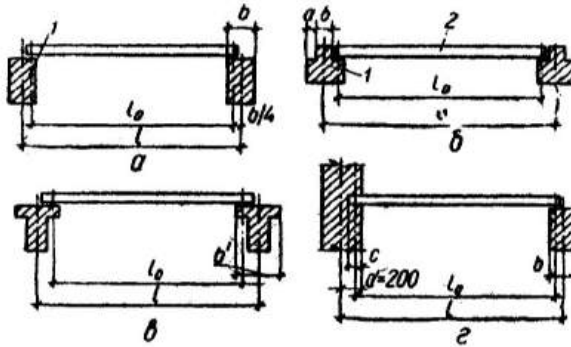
Розрахункові прольоти плит: a – при прямокутних ригелях; b та e – при ригелях таврової форми; z – при обпиранні плити одним кінцем на стіну; 1 – ригелі; 2 – плити
